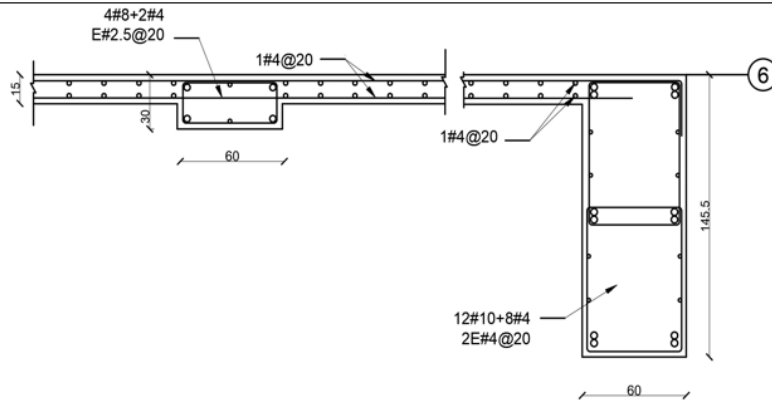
Ejemplo de sección transversal de muros E por nivel de fachada Este (adaptado de SRE, 1963).
